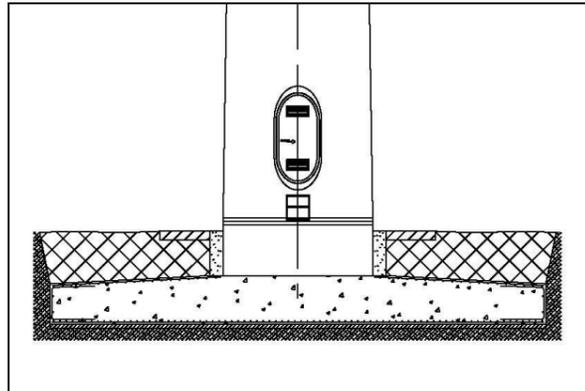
Schéma-type d'une fondation (source : GAMESA, 2014)
